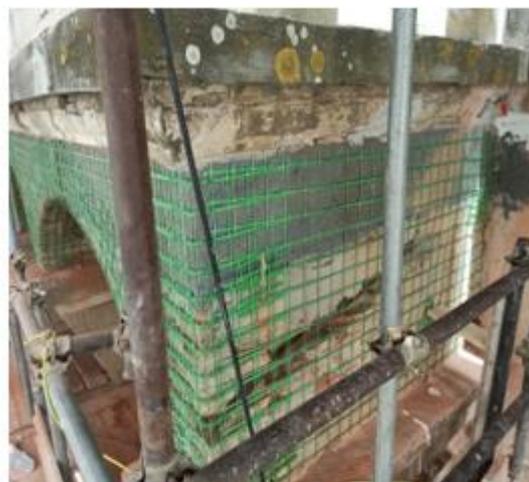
Alcuni dettagli della posa della rete in GFRP del sistema RI-STRUTTURA. Foto @Emilio Prete
